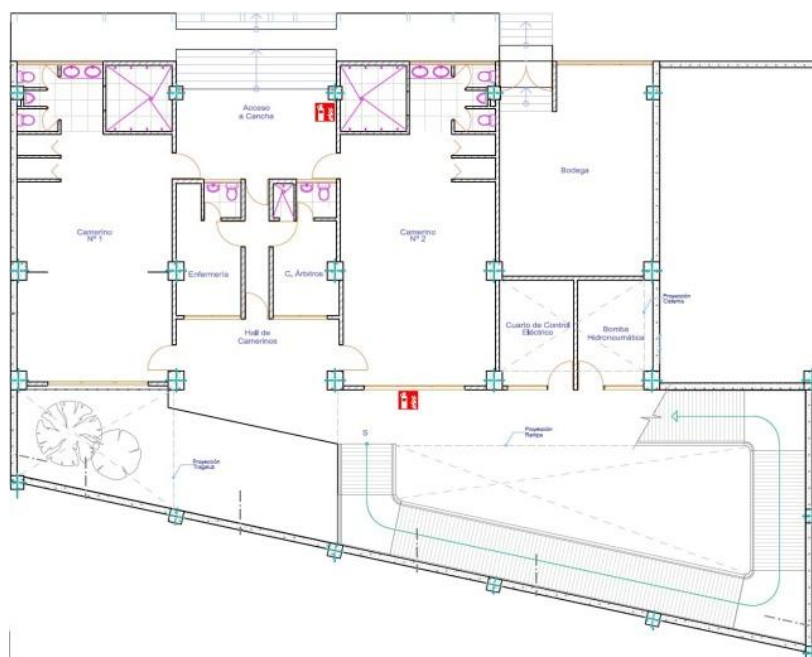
Ubicación de los extintores en la segunda planta sub suelo
